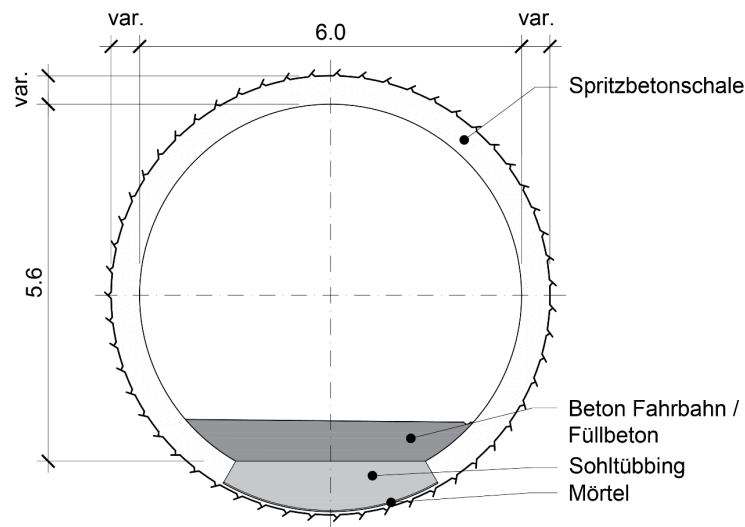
Beispielhaftes Normalprofil Lüftungstunnel HAA, Bautunnel HAA, Betriebstunnel HAA, Querverbindungen HAA und Abzweigertunnel HAA
